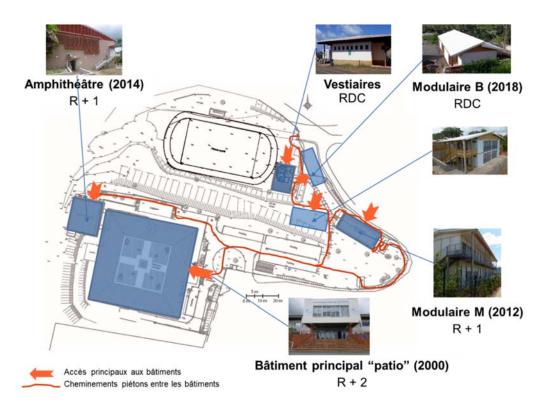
Plan de masse du site et caractéristiques des bâtiments
